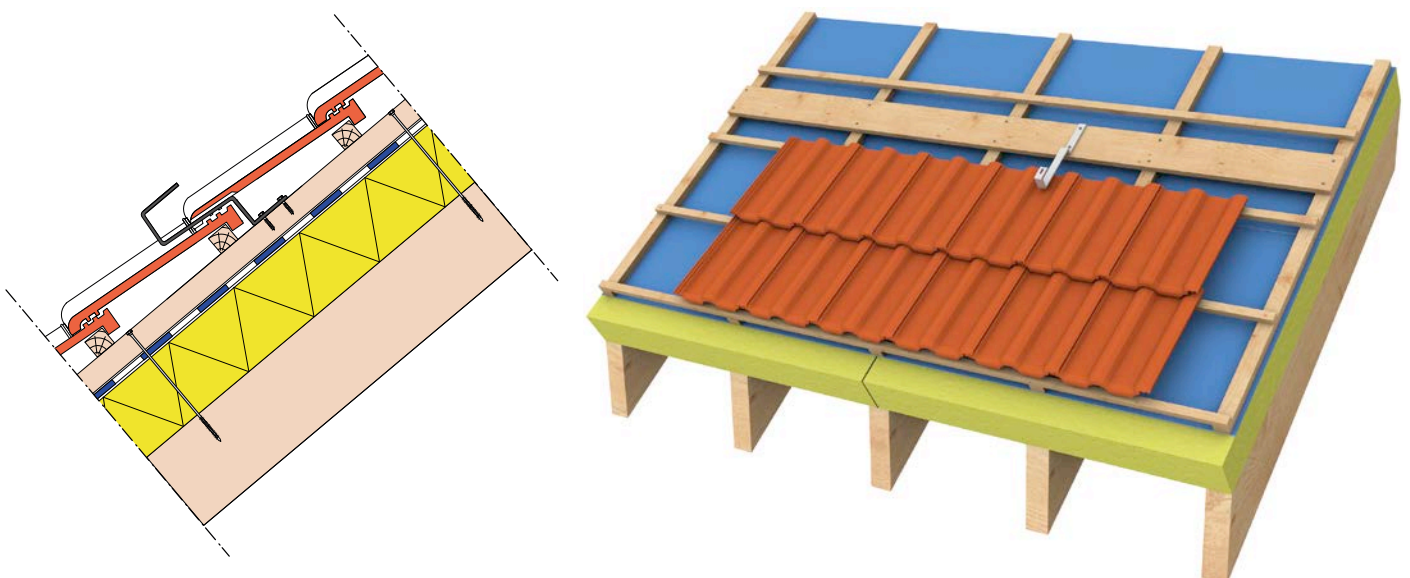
Fixation d'un crochet dans les contre-lattes d'une toiture de type sarking.
